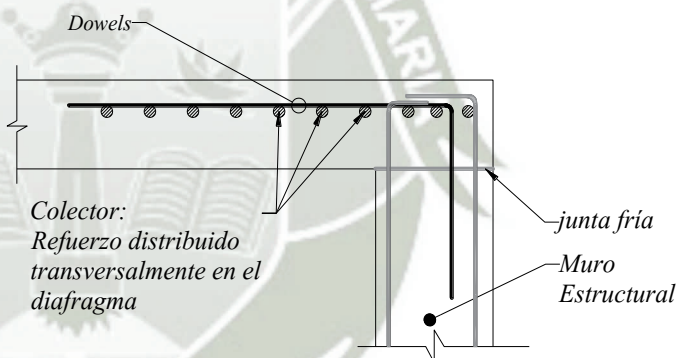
Detalle típico mostrando dowels colocado para transferir a un muro estructural a través de cortante-fricción. [ACI 318-14 R12.5.3.7](#)
